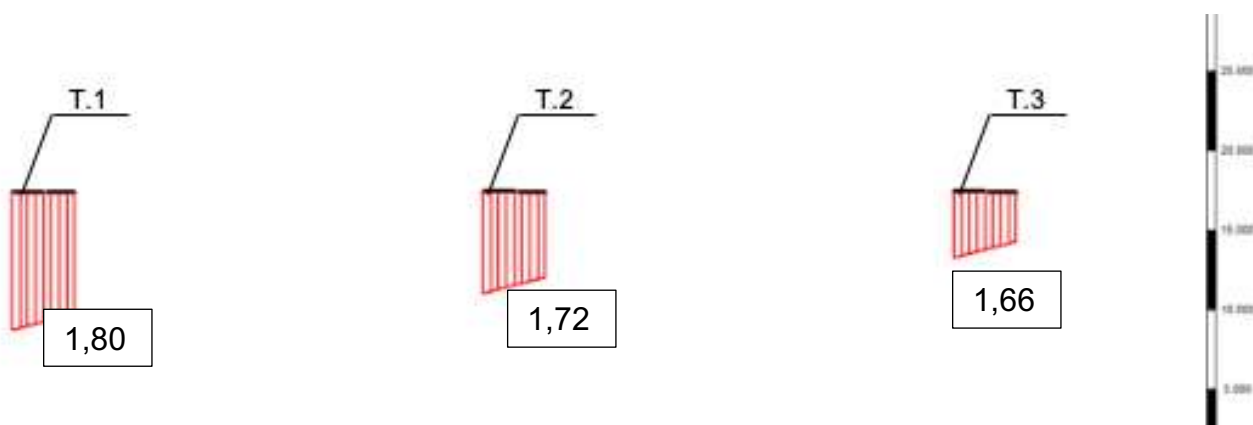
Эпюра вертикальных перемещений фундаментов здания №3 (мм)
